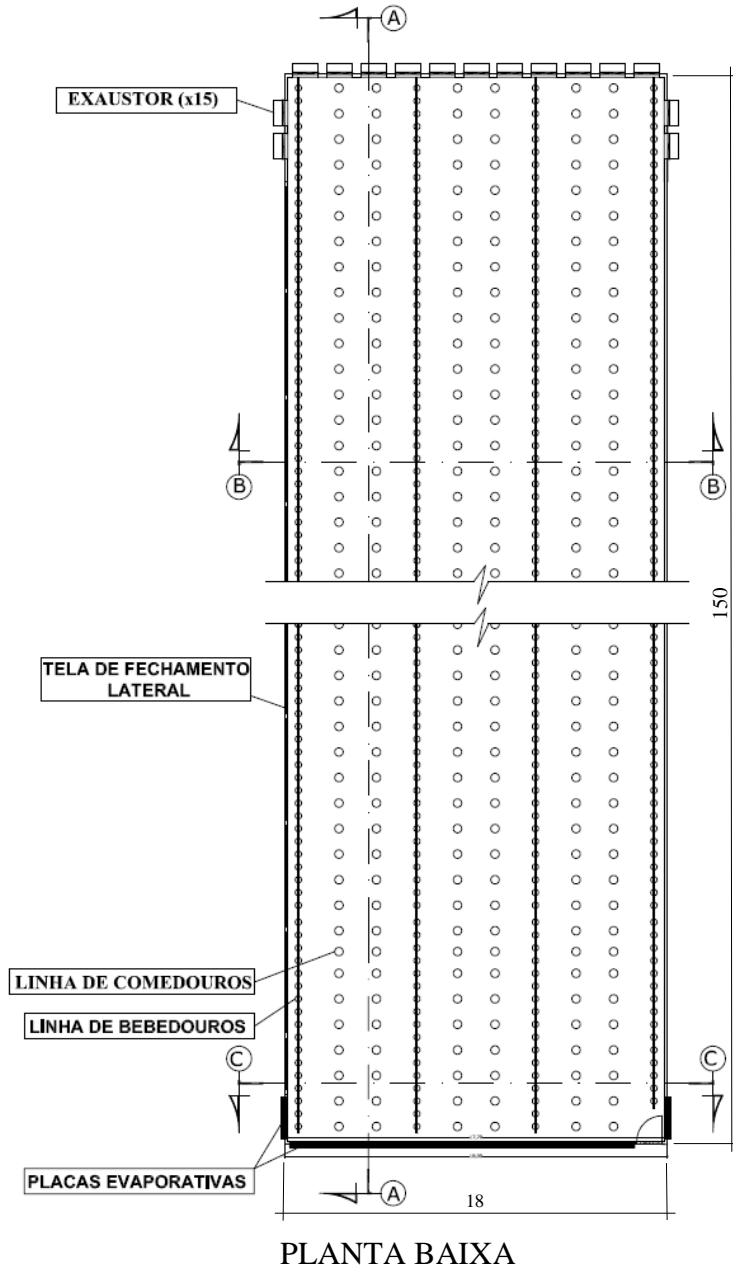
Planta baixa do galpão tipo *Darkhouse*.
